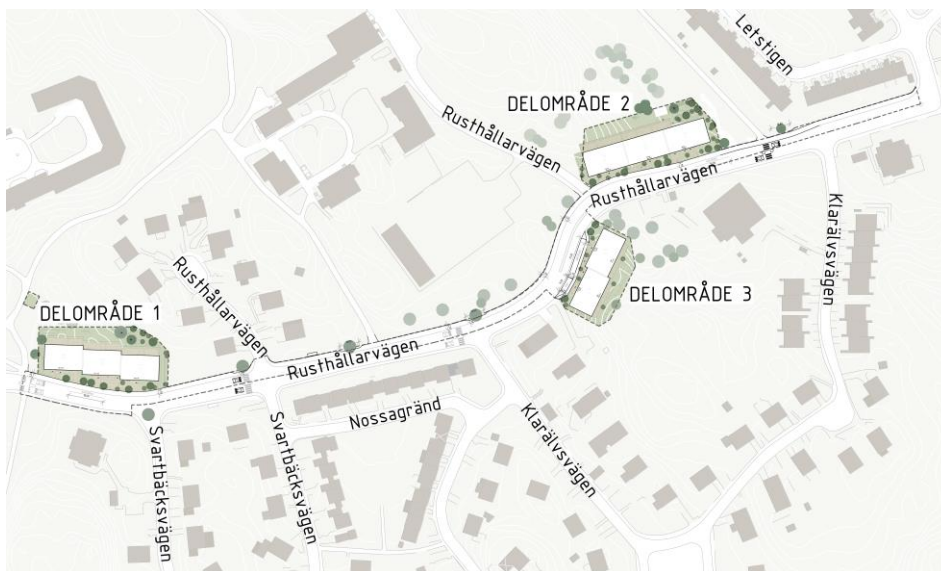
Översikt befintlig parkering och angöring på allmän platsmark inom planområdet.
